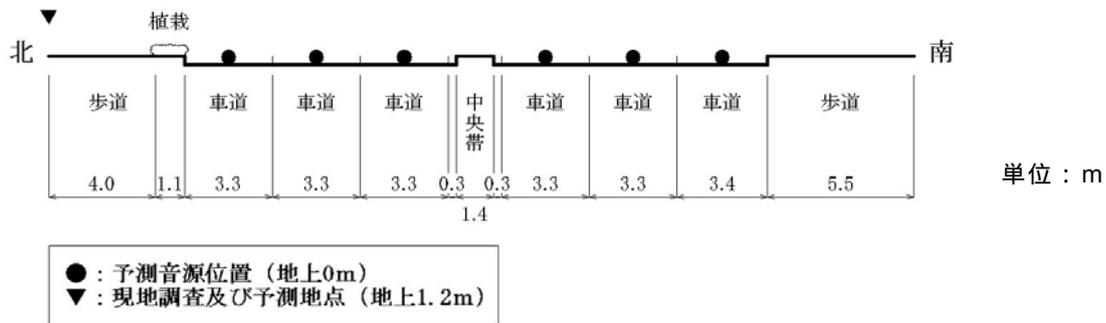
(2) 音源配置図（道路断面方向の配置イメージ： 3断面の例）
